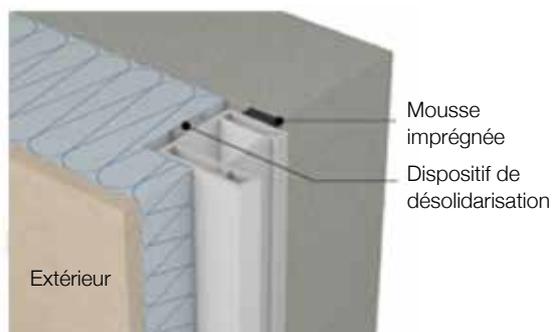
Principe de pose de mousse imprégnée en applique extérieure
